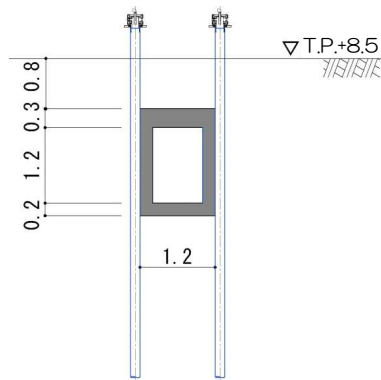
【3-1】排水ヒューム管① 施工方法（複列施工）
